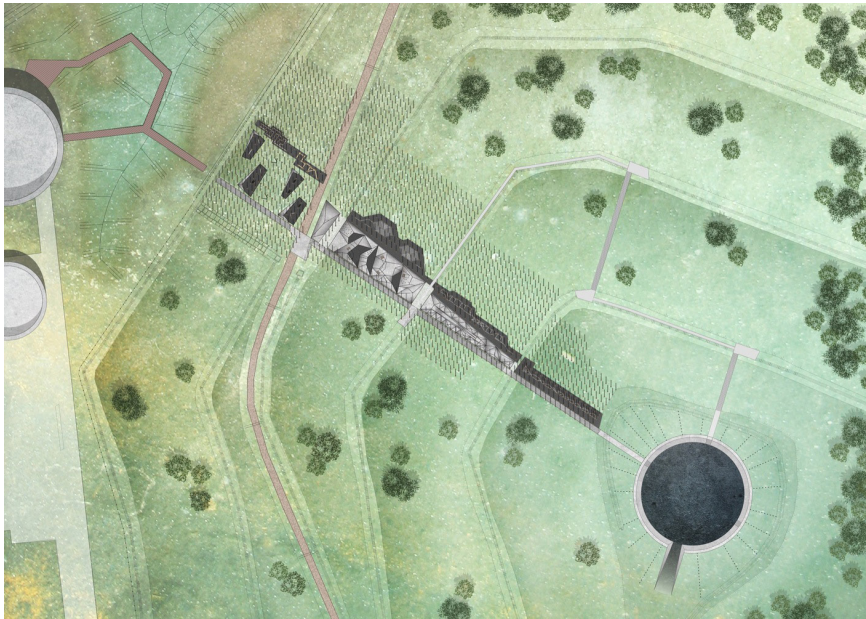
Planta de Emplazamiento Play Landscape be-Mine. Fuente: Landezine
